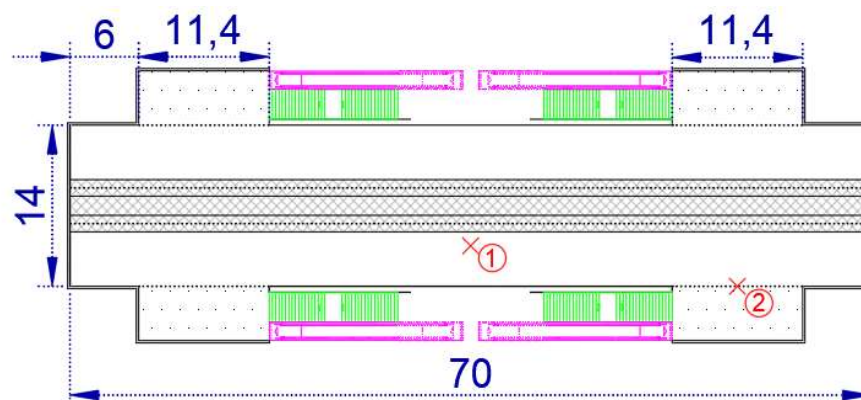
Planta da plataforma da estação Salgueiros com sinalização dos dois pontos utilizados para a medição do ruído de fundo (dimensões em metros)
